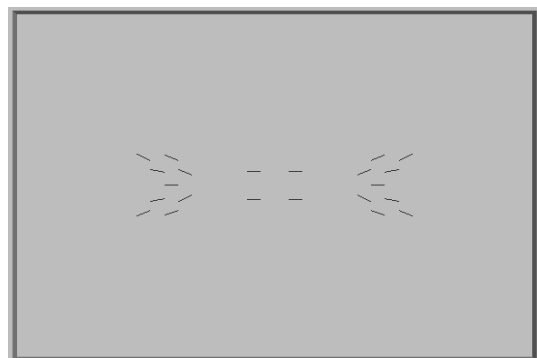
No.4 試験体ひび割れ図 (4 辺固定解析)
